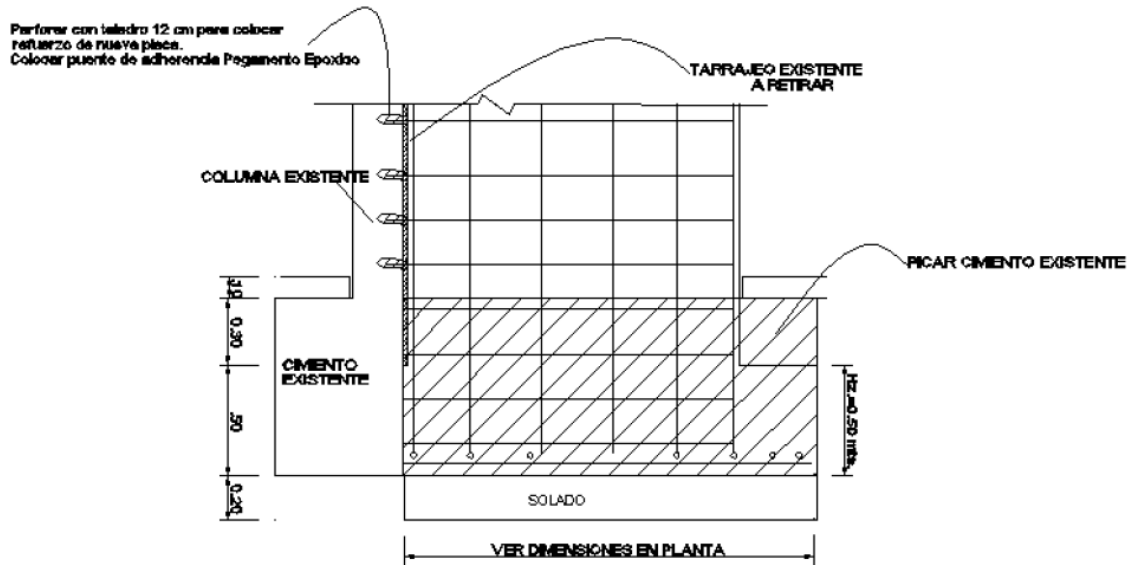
Detalle de refuerzo de columna con placa y su cimentación.
